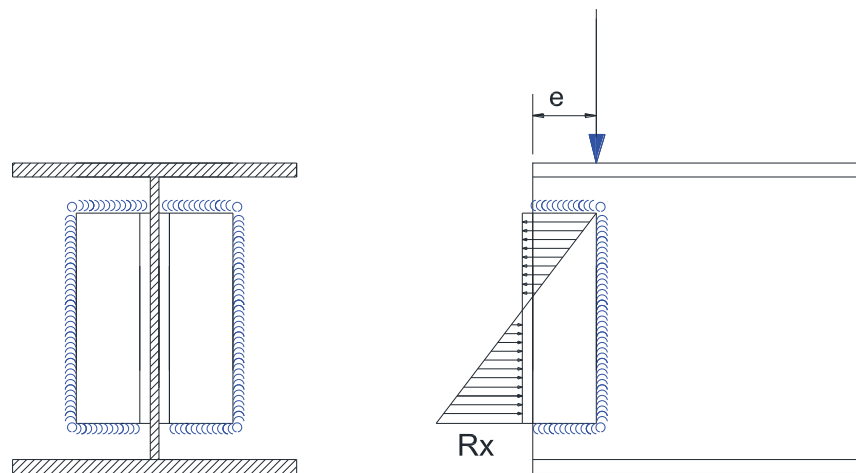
Configuración de la soldadura para conexiones de ángulos
